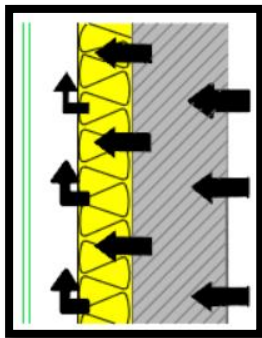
Protection de la façade par évacuation des eaux de condensation
